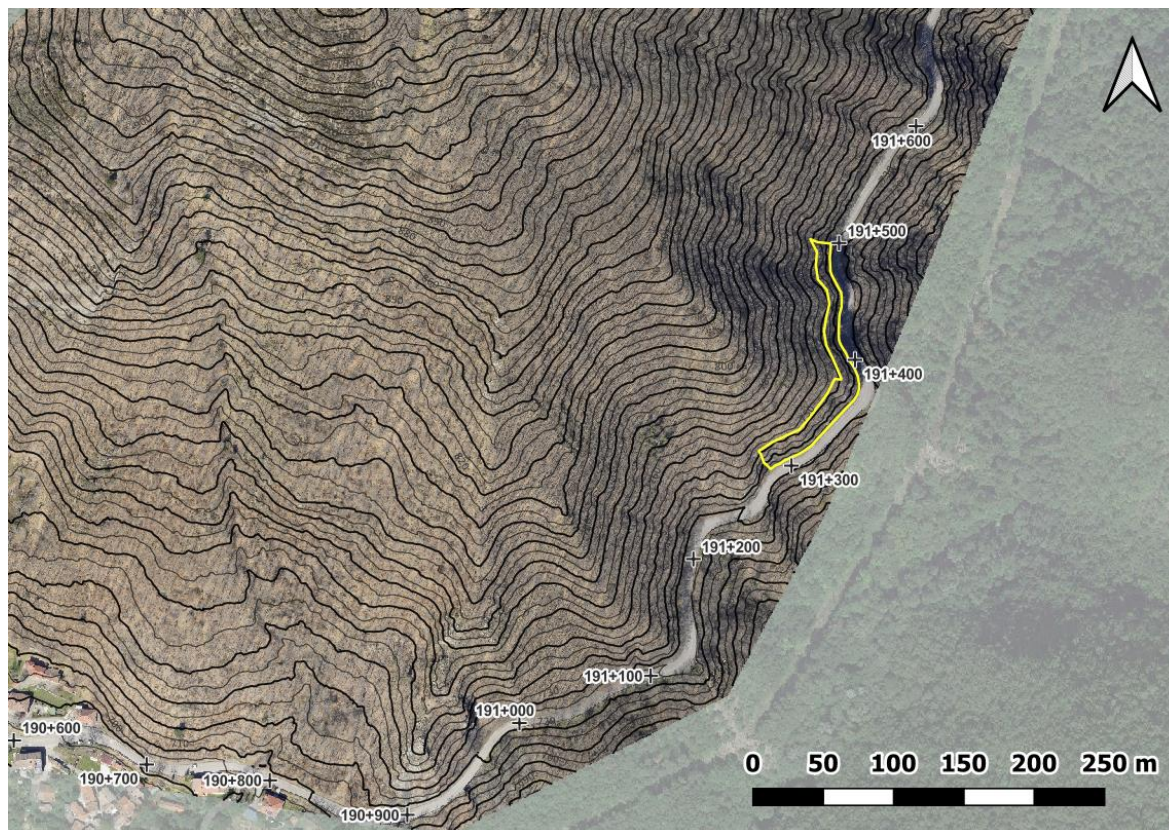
Ubicazione planimetrica dell'area interessata dall'intervento Po.025. Scala grafica
